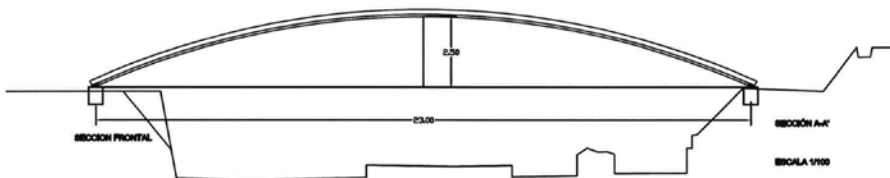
Alzado del conjunto. Plano sin escala. Arquitecto Jorge Suso Fernández Figares
